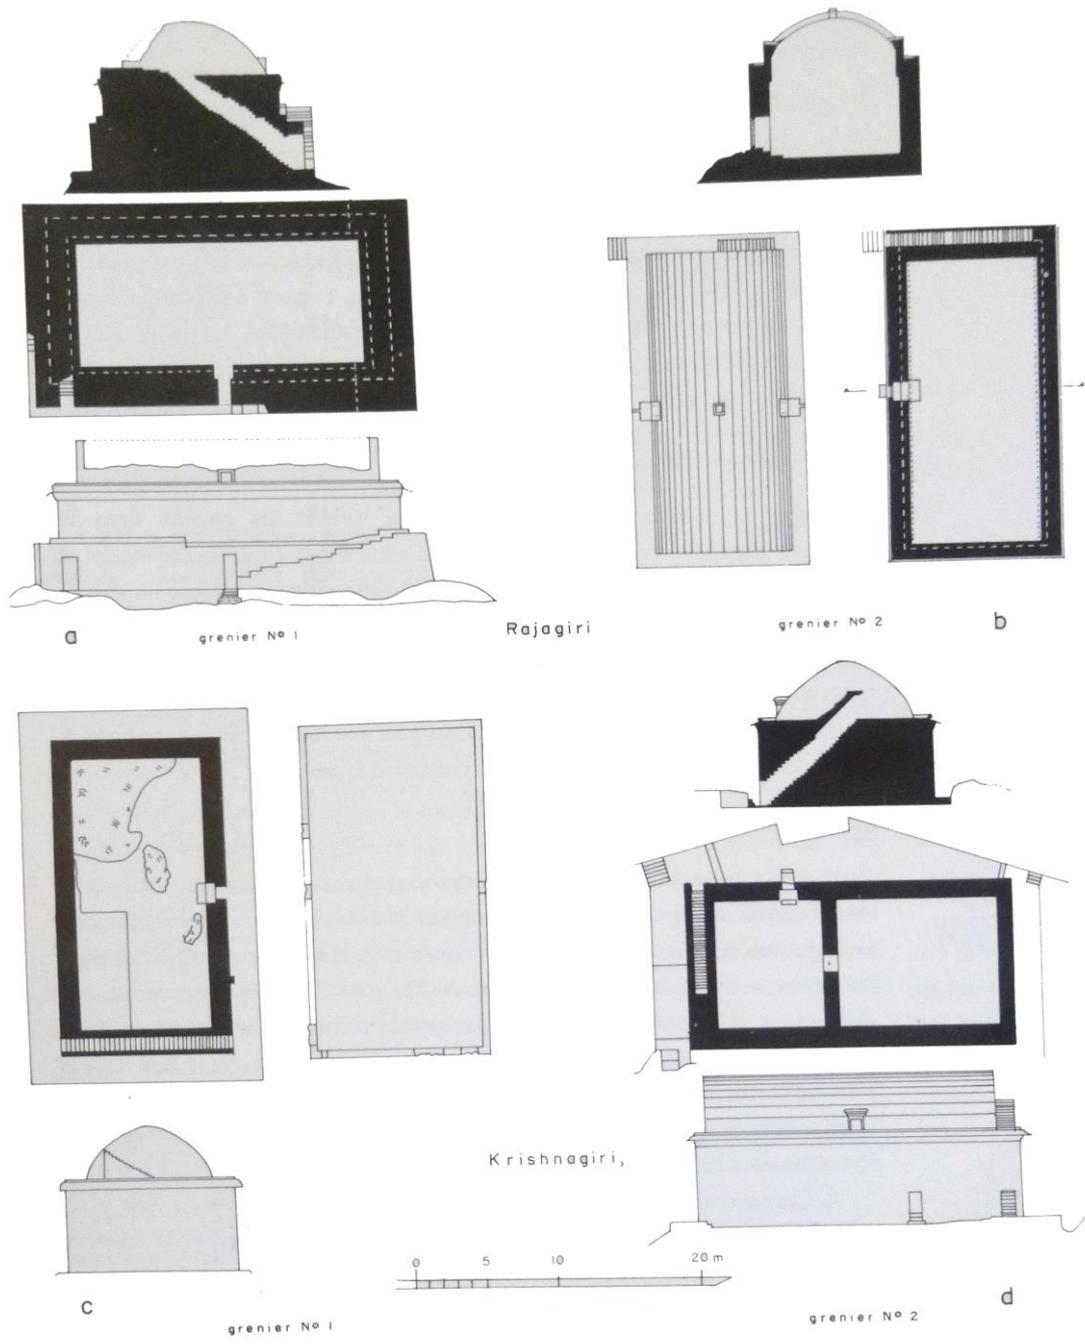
Greniers sur les montagnes (SAV) : Rajagiri, grenier N°1, coupe, plan et élévation, grenier N°2, coupe et plan ; Krishnagiri, grenier N°1, plan et élévation, grenier N°2, coupe, plan et élévation.
